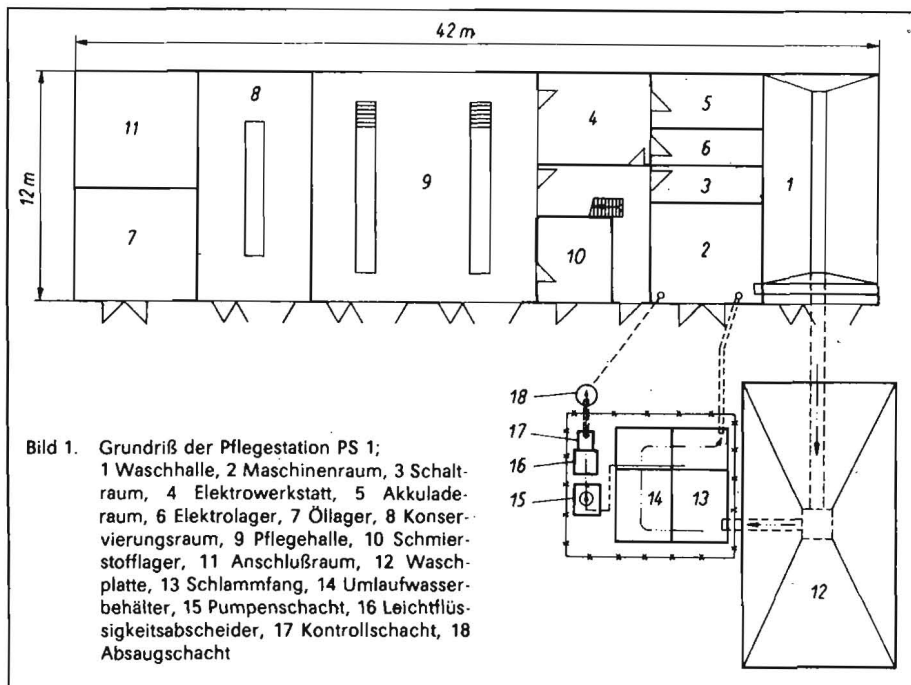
Grundriß der Pflegestation PS 1; 1 Waschhalle, 2 Maschinenraum, 3 Schalt- raum, 4 Elektrowerkstatt, 5 Akkuladearaum, 6 Elektrolager, 7 Öllager, 8 Konservierungsraum, 9 Pflegehalle, 10 Schmierstofflager, 11 Anschlußraum, 12 Waschplatte, 13 Schlammfang, 14 Umlaufwasserbehälter, 15 Pumpenschacht, 16 Leichtflüssigkeitsabscheider, 17 Kontrollschacht, 18 Absaugschacht
